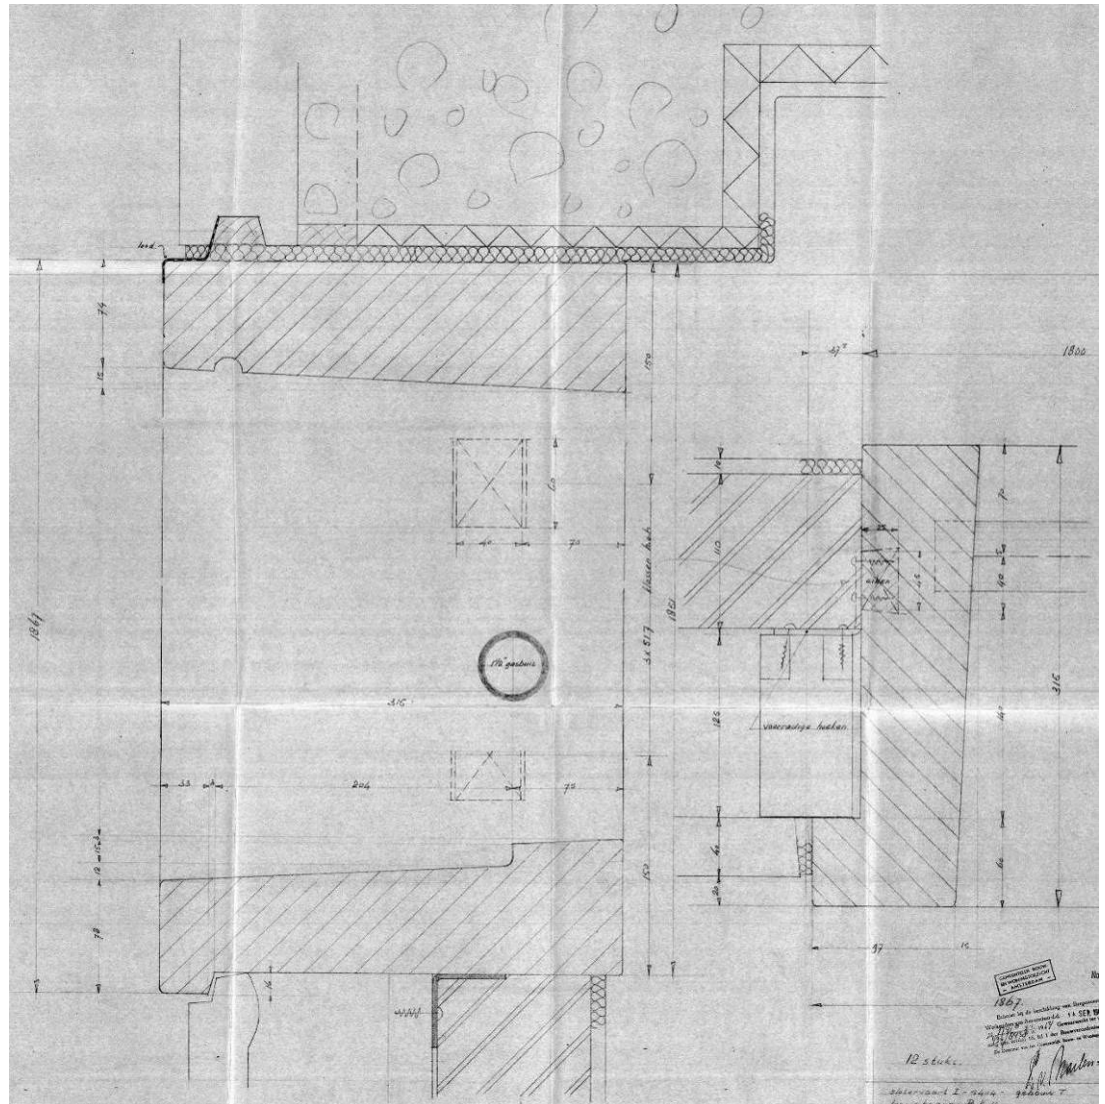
Blok T (Toren) de betonnen kaders, rond kleine loggia's, vertikaal en horizontaal, februari 1959 (Bowoto 4839-01).
